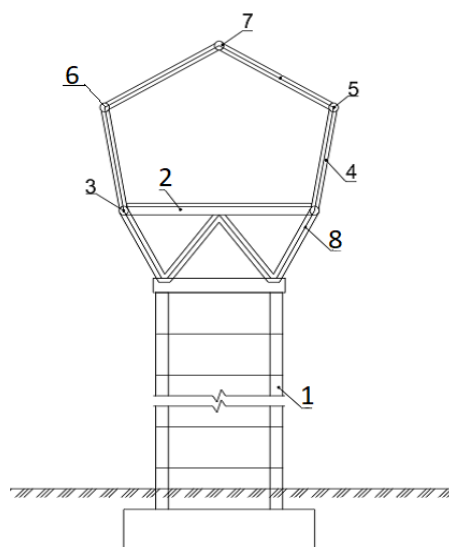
Эскиз транспортной эстакады для велополитена: 1 – опоры; 2 – железобетонная плита проезжей части; 3 – стержни нижнего пояса сквозной конструкции; 4 – наклонные элементы – раскосы, жёстко связанные с плитой проезжей части; 5 и 6 – стержни верхнего пояса сквозной конструкции; 7 – дополнительная наклонная связь, жёстко связанная своими концами со стержнями верхнего пояса; 8 – узлы, допускающие продольные смещения пролётных строений
